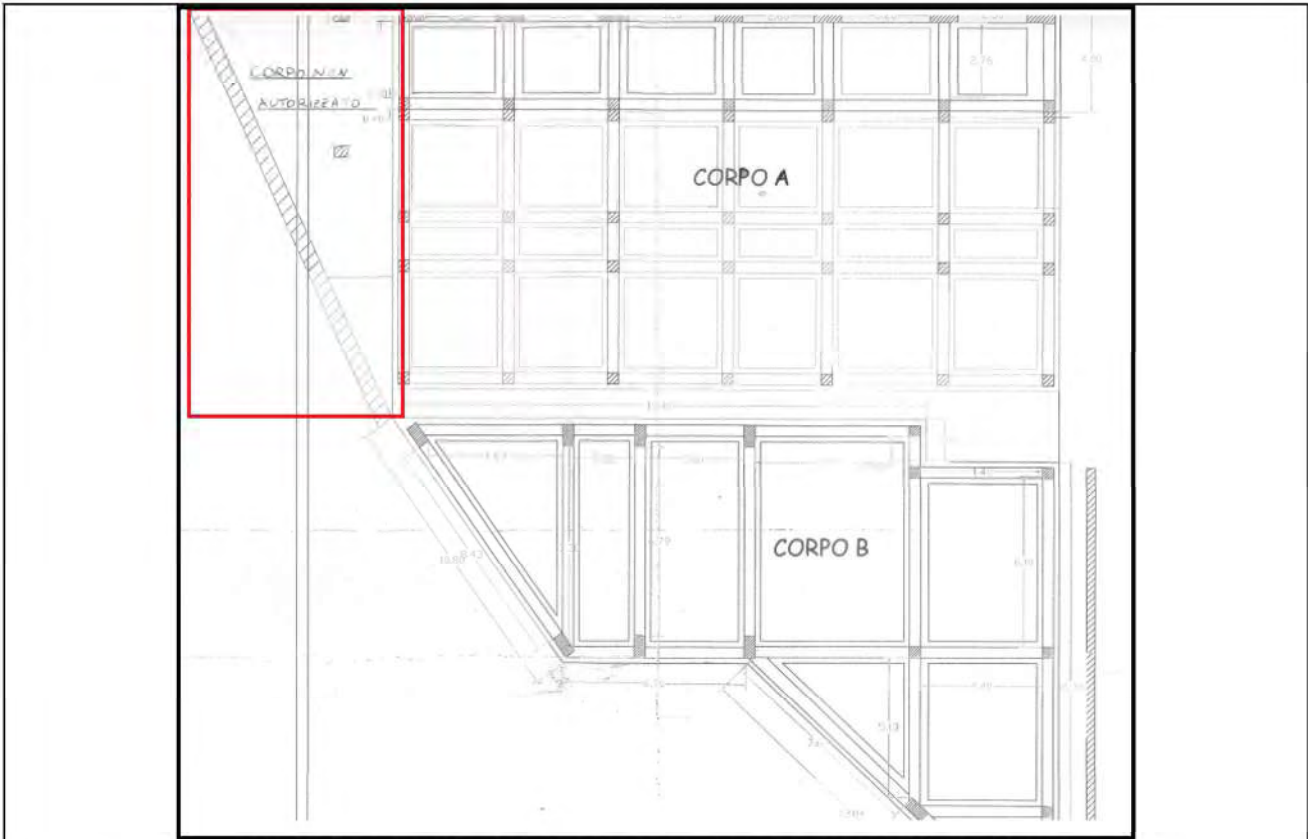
Rappresentazione planimetrica del corpo non autorizzato nel riquadro rosso.
